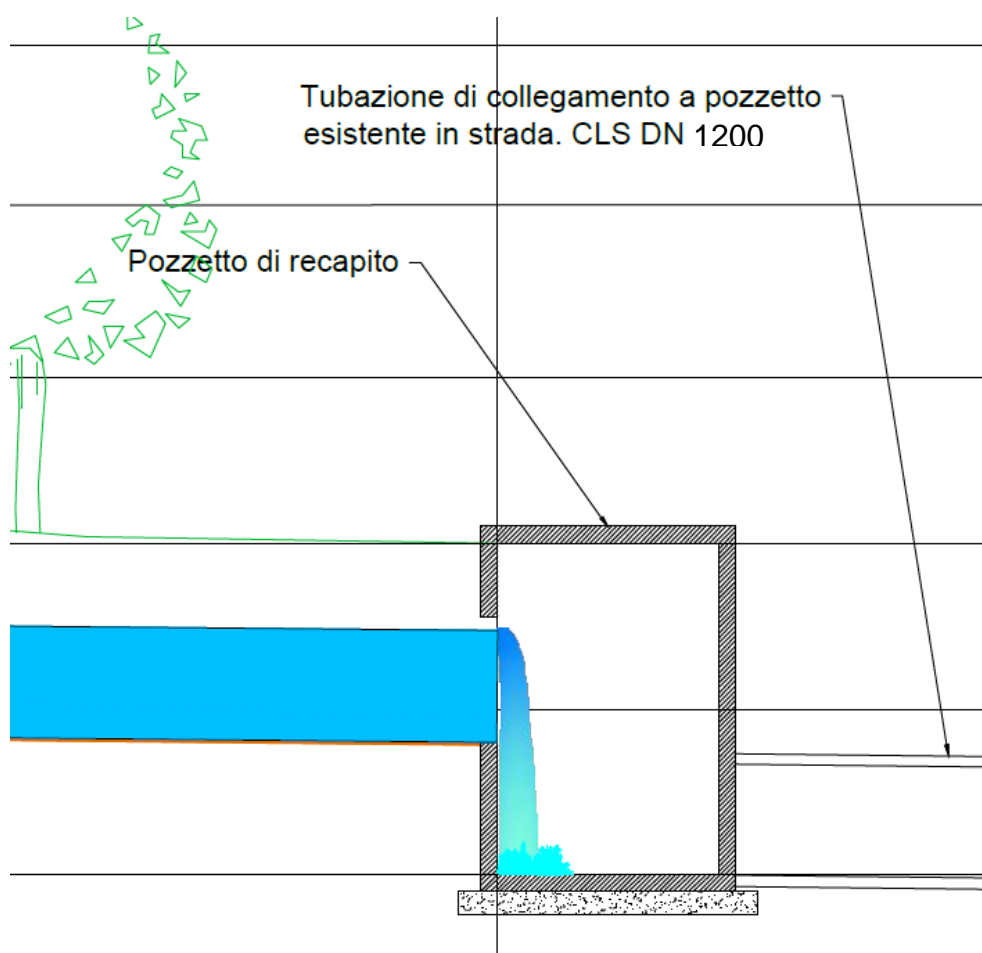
Pozzetto di recapito finale e collegamento col pozzetto esistente lungo la SP26
